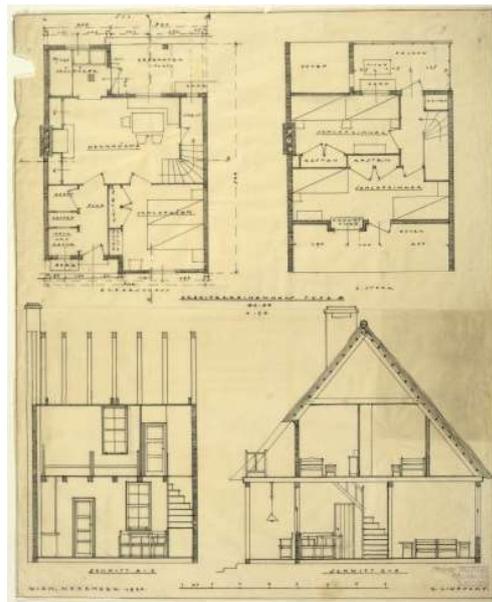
Arbeiter-Reihenhaus Type III. Grundrisse und Schnitte, 1920.
